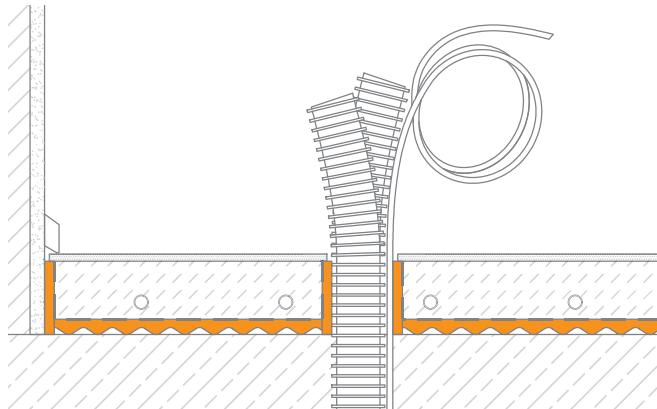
Ausführungsdetail mit beheiztem Nassestrich
